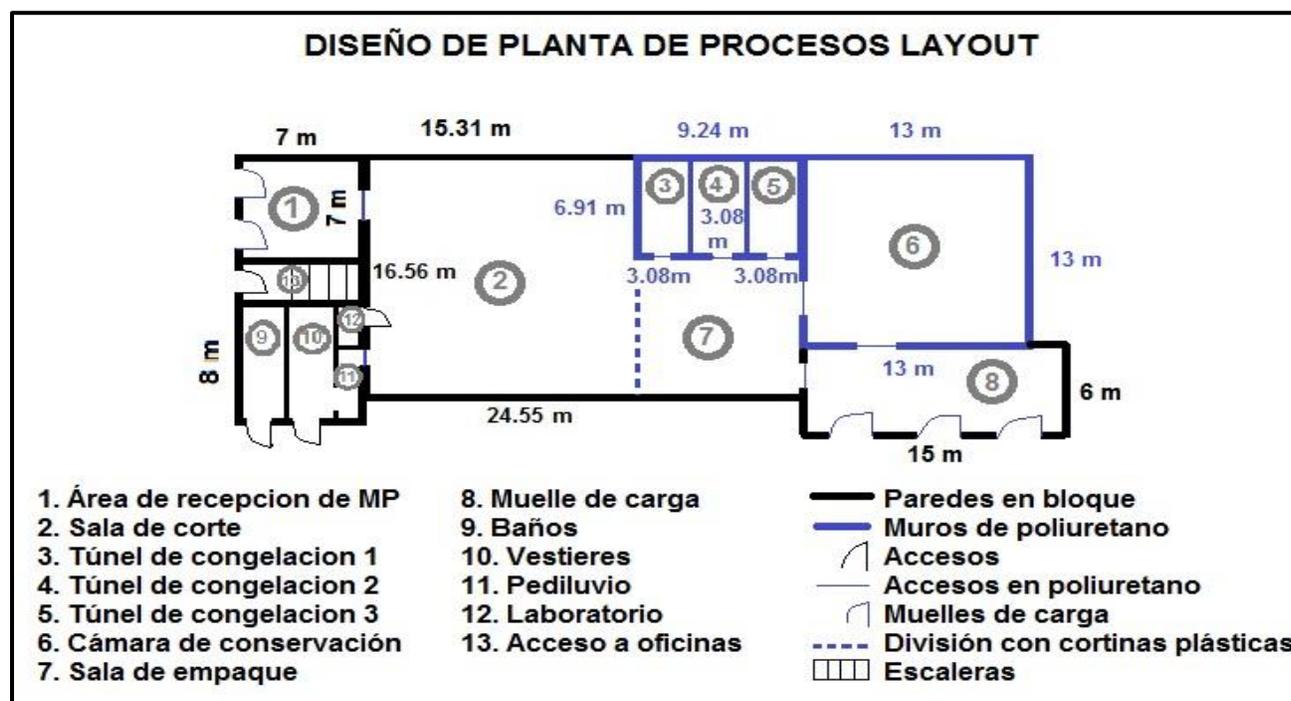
Diseño de Planta Lay out. Fuente: Propia del estudio.
